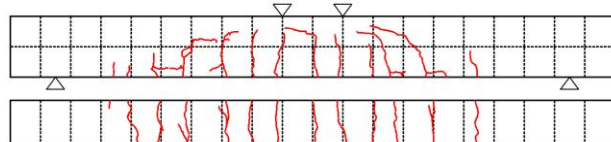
L-45 終局時ひび割れ図（下段は下面）（56.4 万回）
